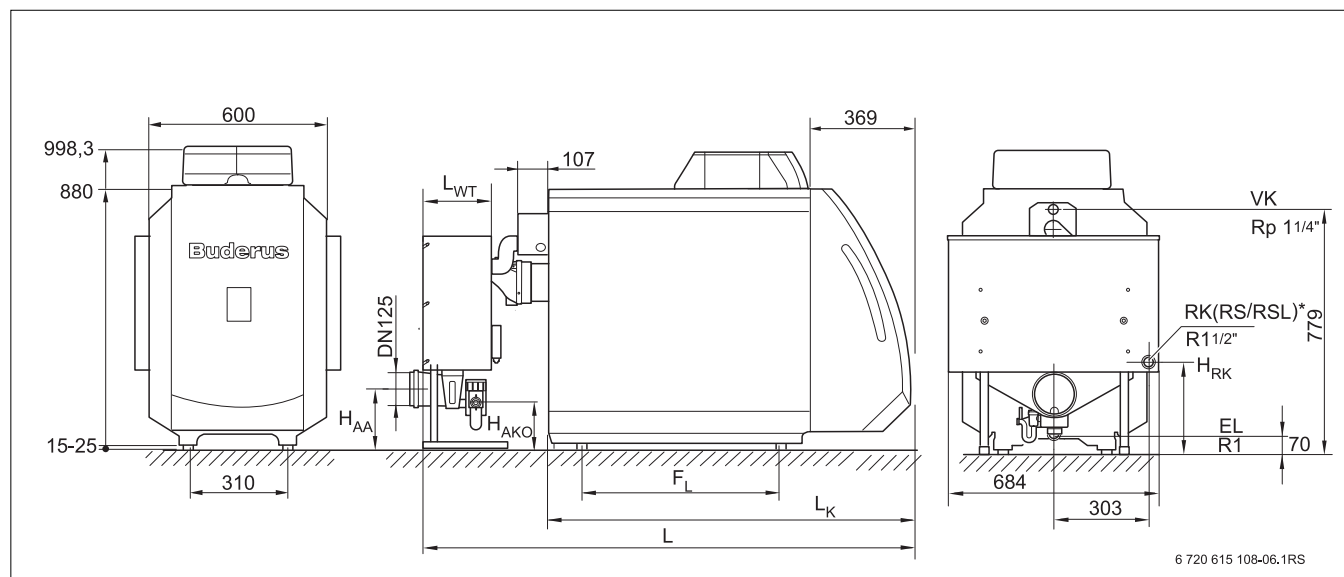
Anschlüsse und Abmessungen (Maße in mm)
